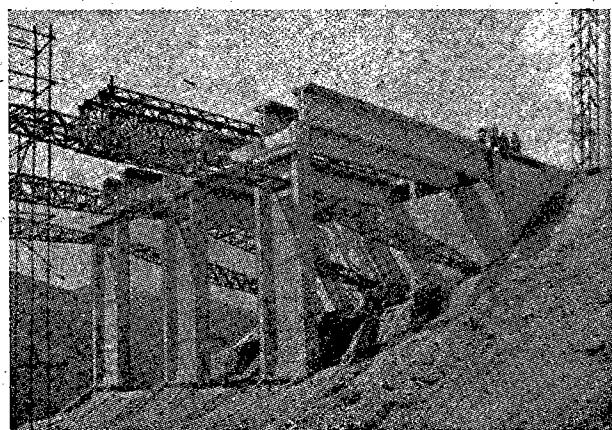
Předvyrobené Freyssinetovy klouby pro nosné stěny
